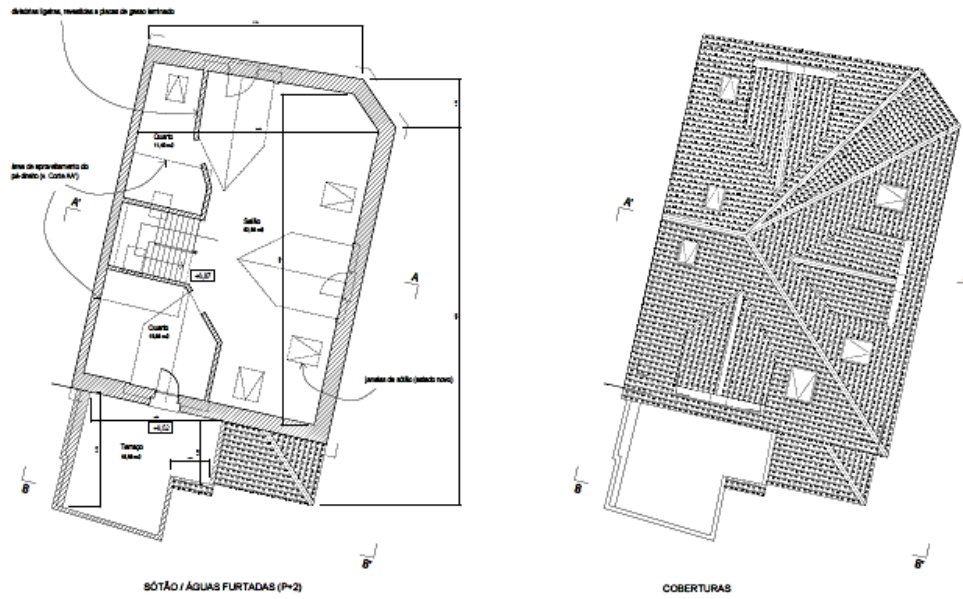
Planta do sótão e de cobertura (plantas fornecidas pela câmara).
